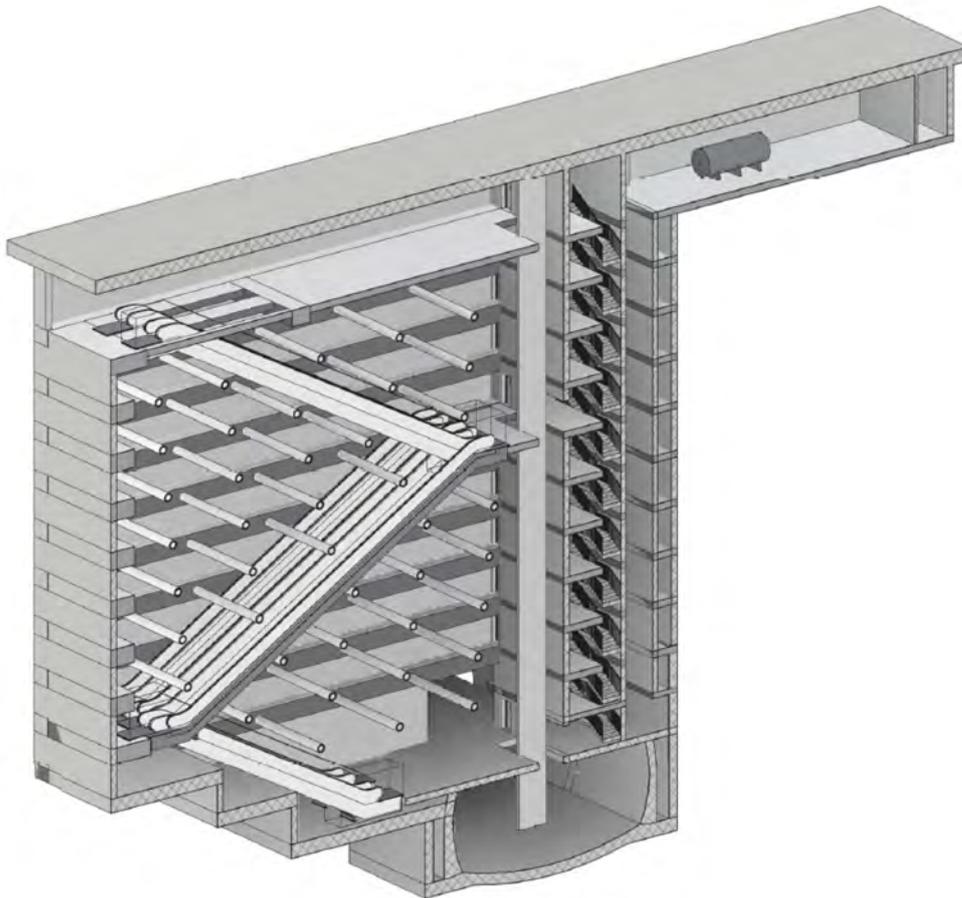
Assonometria della struttura del pozzo di collegamento.
